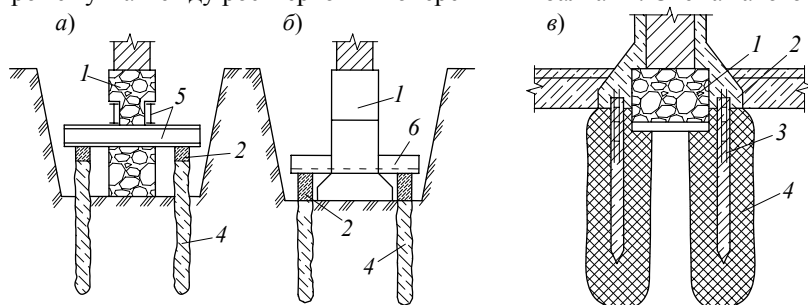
Варианты усиления ленточных (а, б) и столчатых (в) фундаментов набивными сваями:
